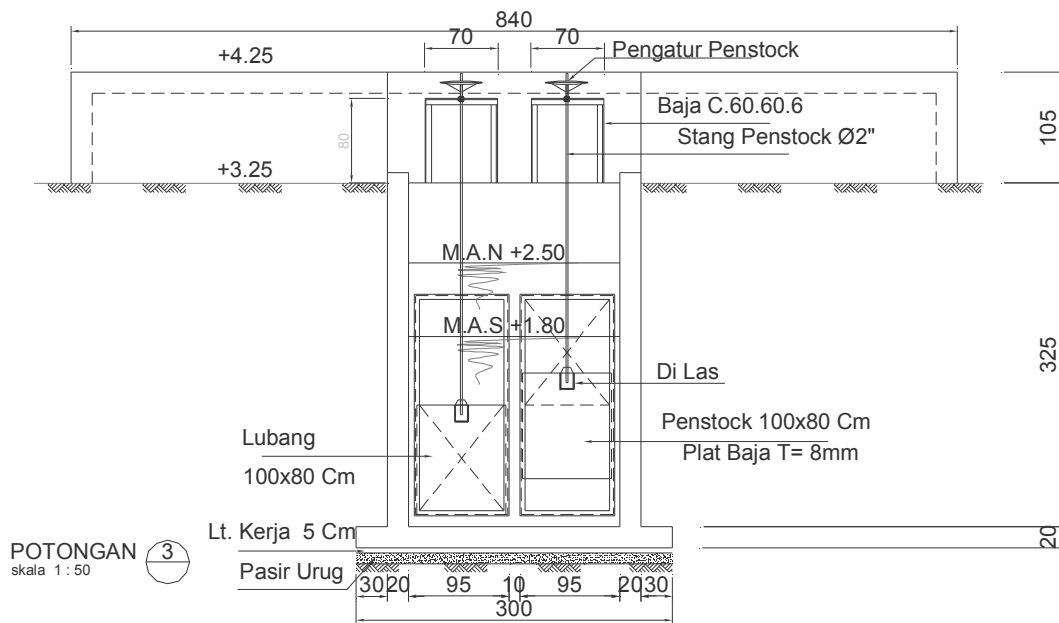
Detail A bangunan pengambilan bebas dengan pintu air
